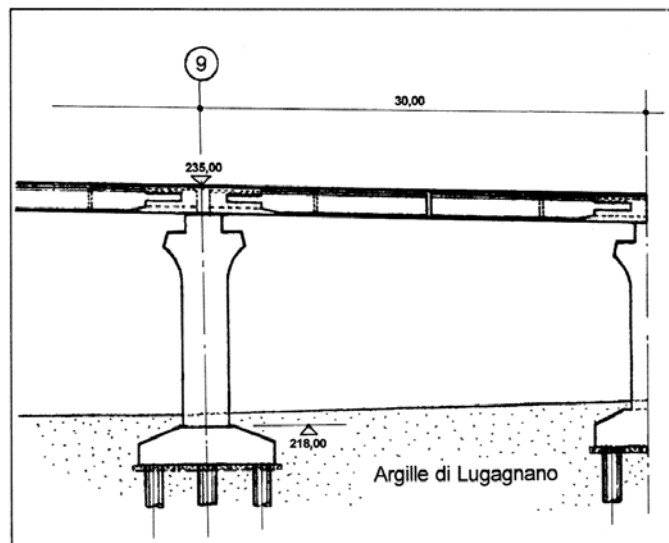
Vista in sezione del pilastro n. 9, le cui fondazioni hanno interessato le argille plioceniche oggetto del campionamento.
